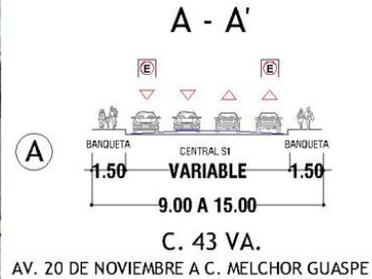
Vista de la C. 43 va. y su sección vial actual.
